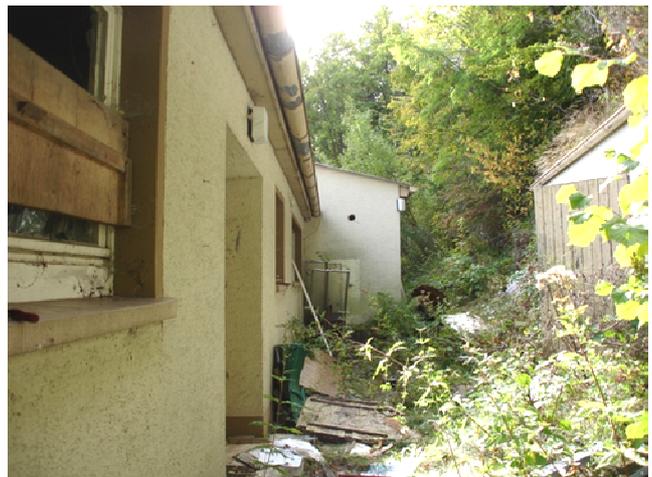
Ansicht Haus 3 entlang der NW-Fassade
